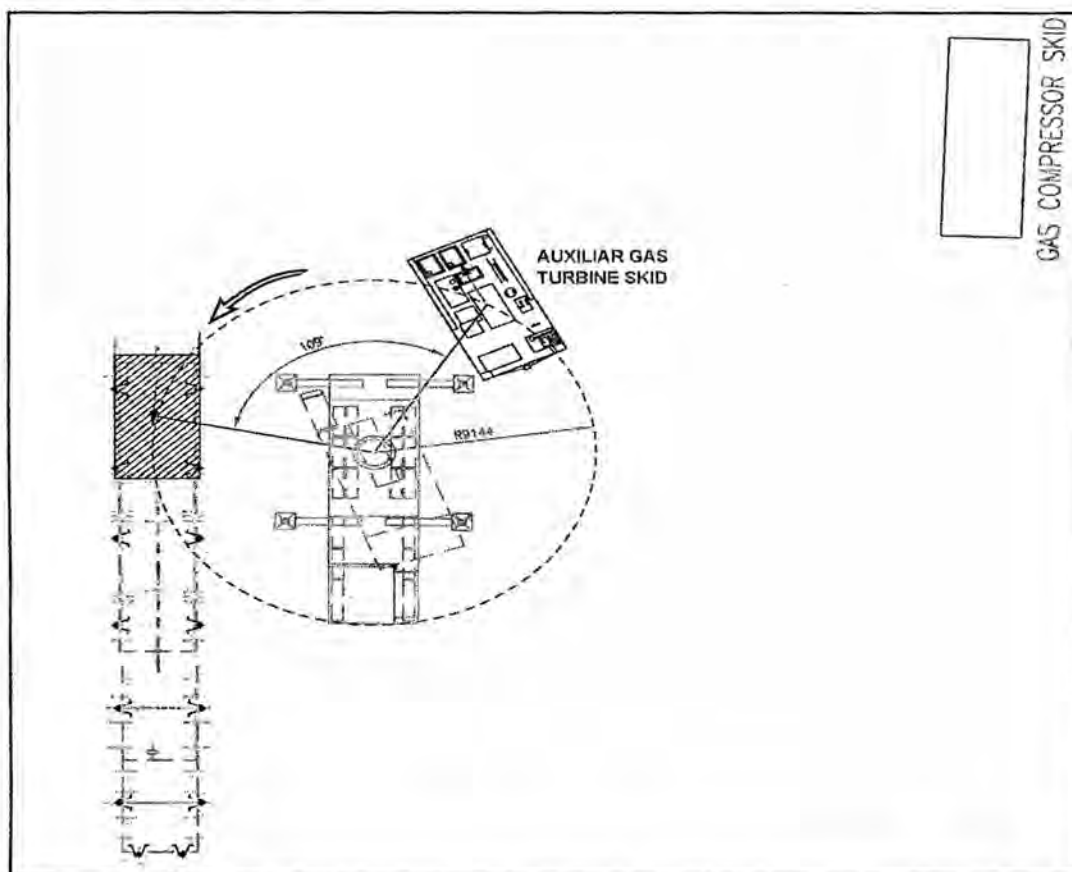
Esquema de montaje del auxiliar gas turbine skid
